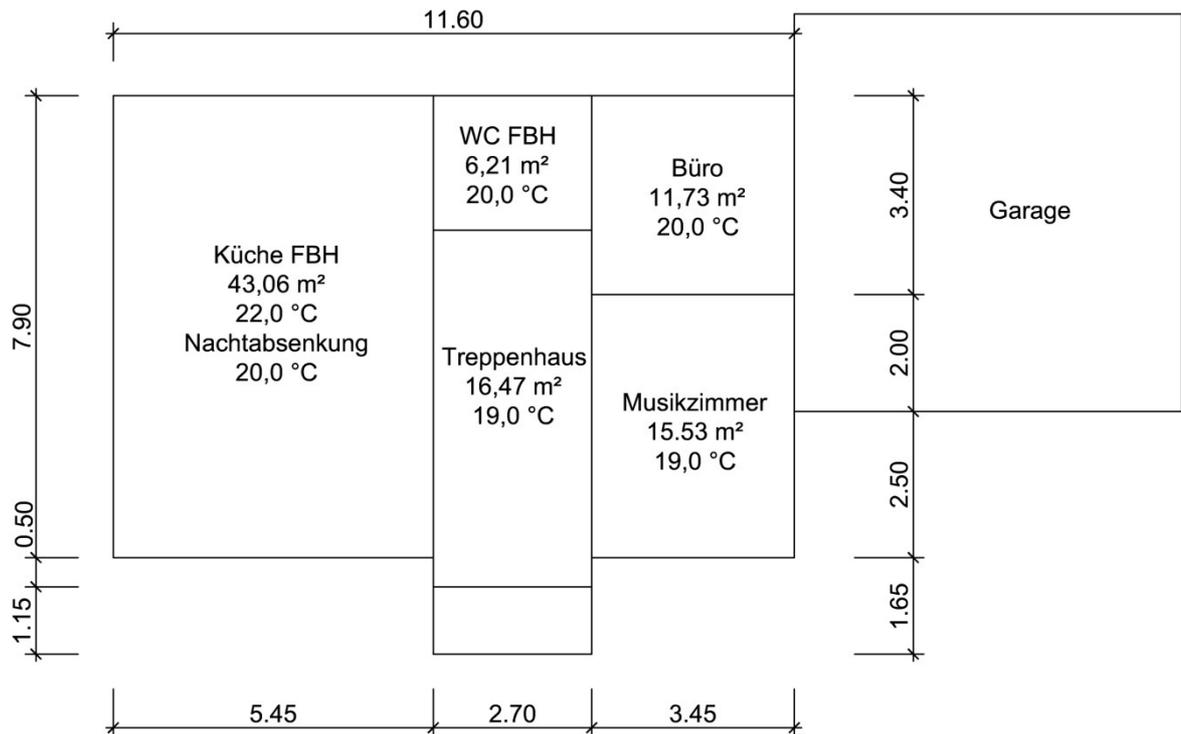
Grundriss: konditioniertes Erdgeschoss
